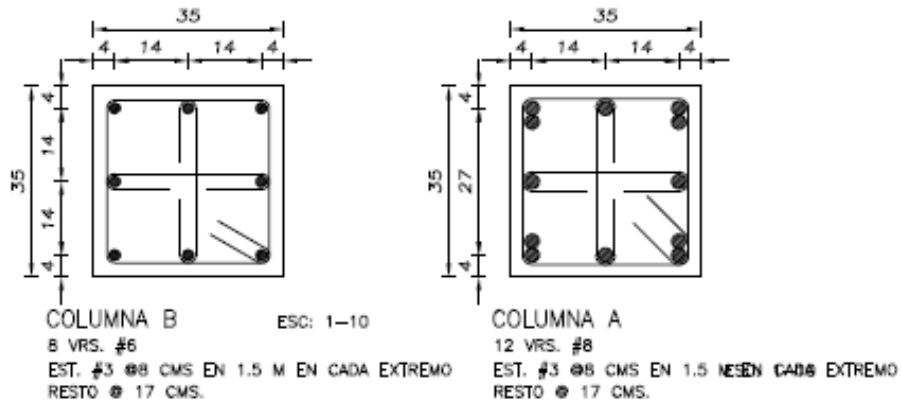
Detalle de cimentación y sección de columnas en sótano
